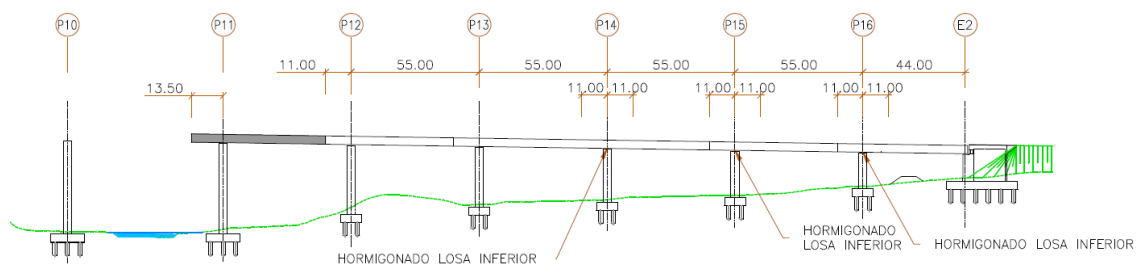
Fase 8: izado del vano 11 y hormigonado de la losa inferior sobre pilas 14, 15 y 16. Fuente: Proyecto de construcción de plataforma del corredor mediterráneo de Alta Velocidad Murcia – Almería.
